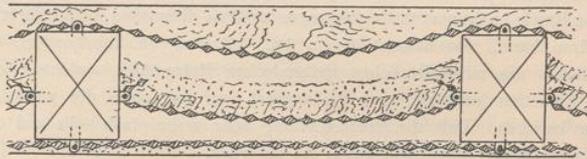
Drahtziegelverwendung bei Holzbalkendecke zum Deckenputze, zur Zwischendecke und zum Betonfußboden.
